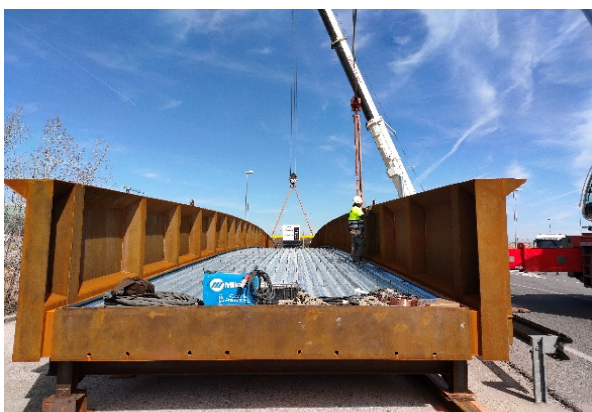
sección de artesa previo al hormigonado de la chapa de fondo.
